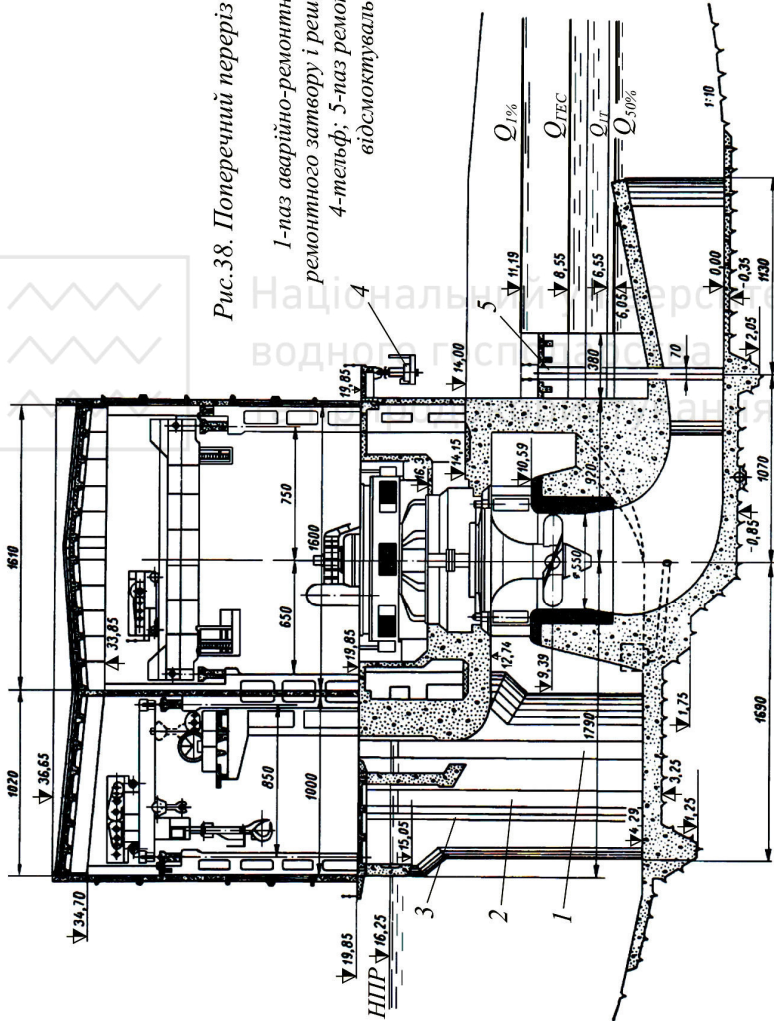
Поперечний переріз машинної будівлі ГЕС;
